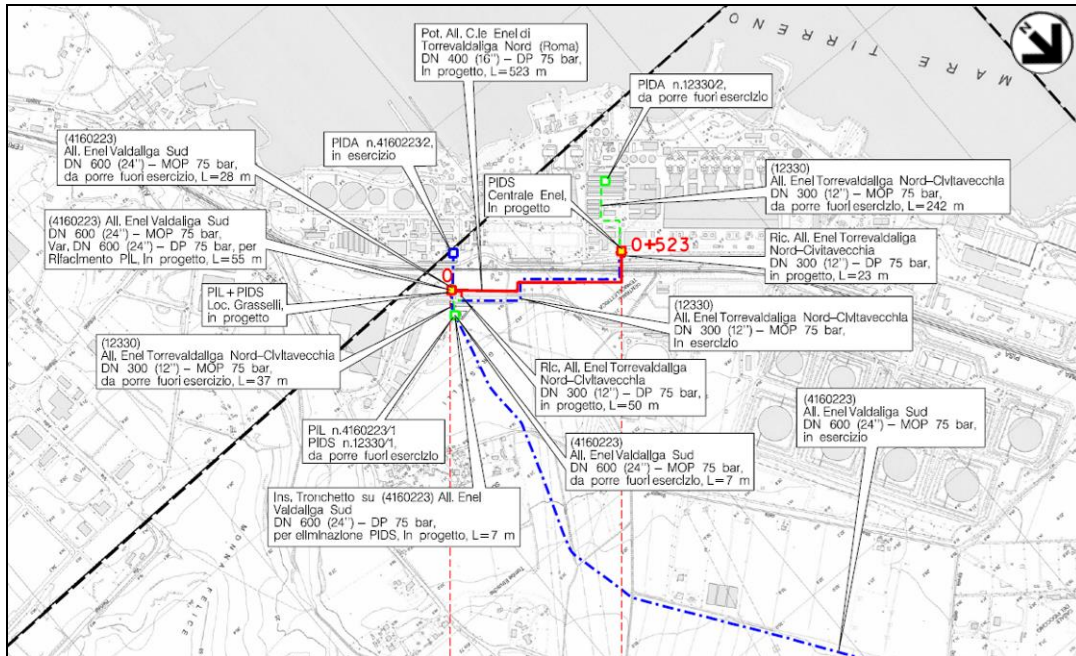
/B – Stralcio planimetrico con localizzazione del tracciato in progetto
